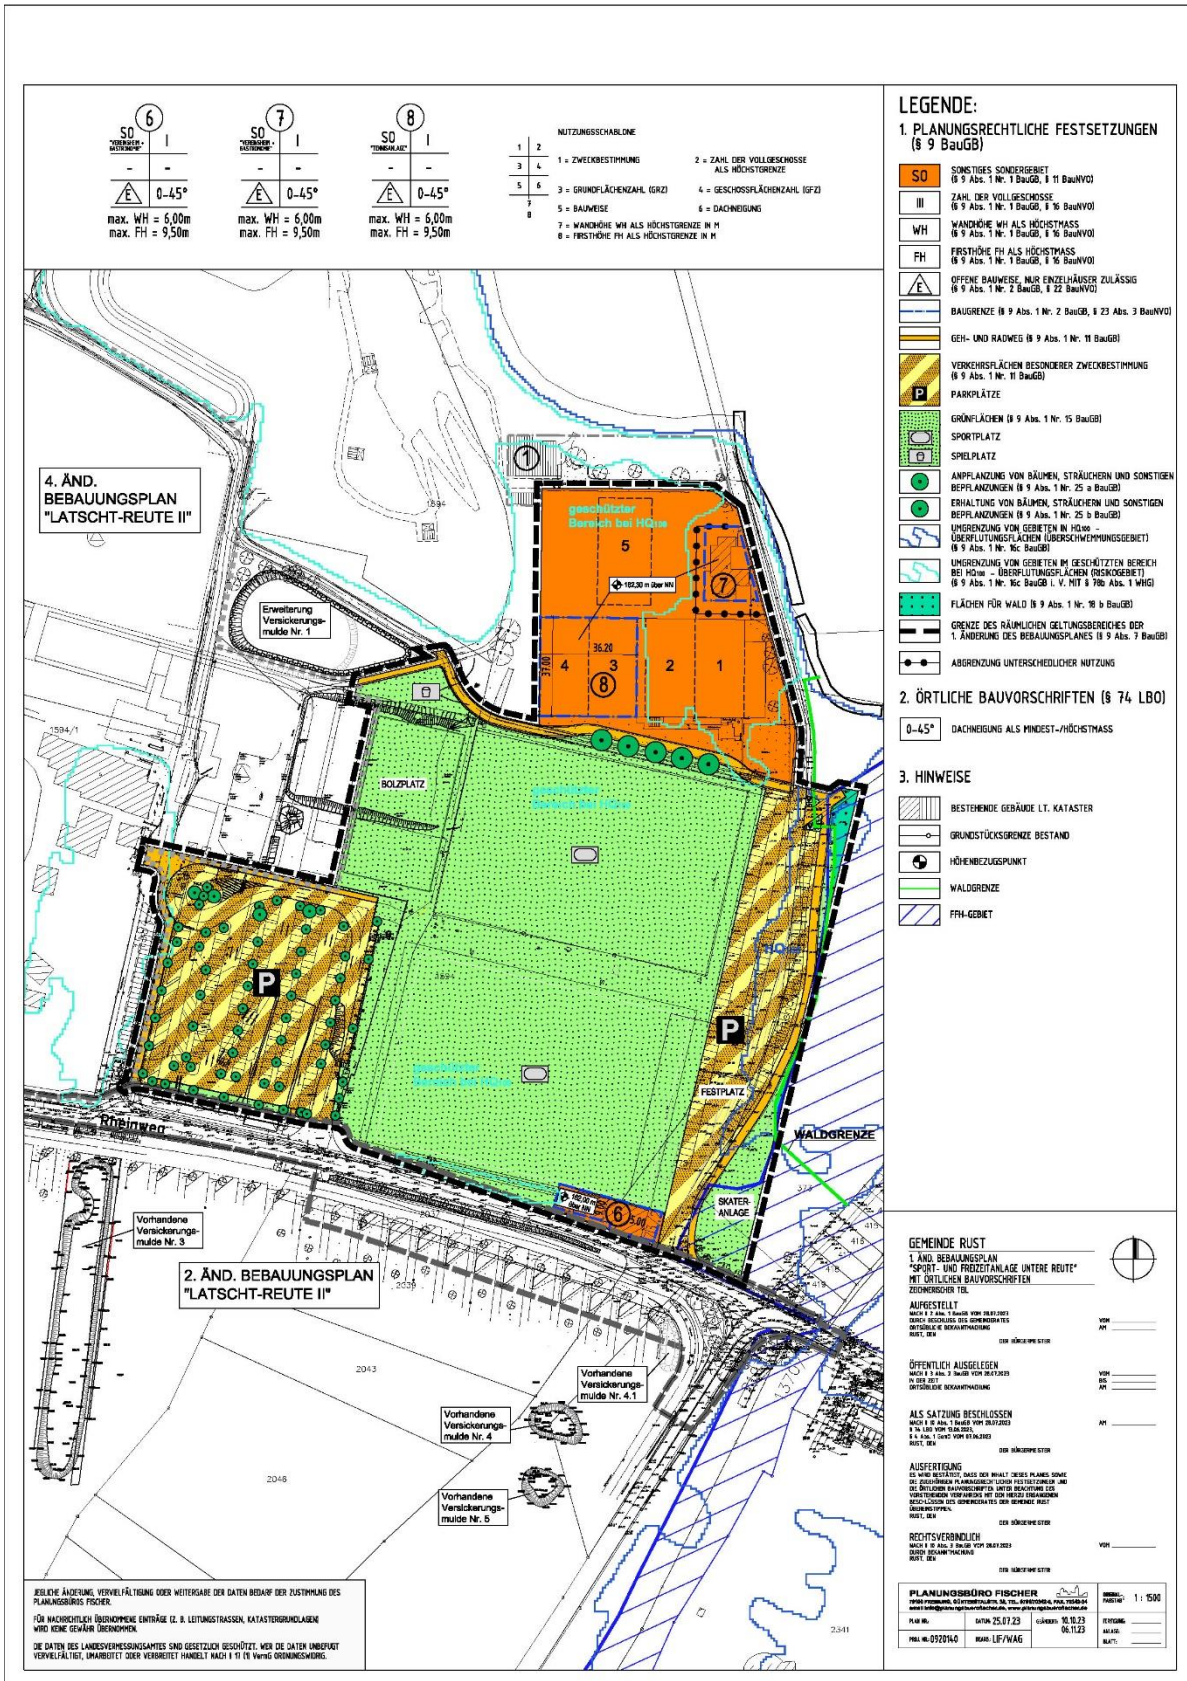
Bebauungsplan (Quelle:Büro Fischer)
